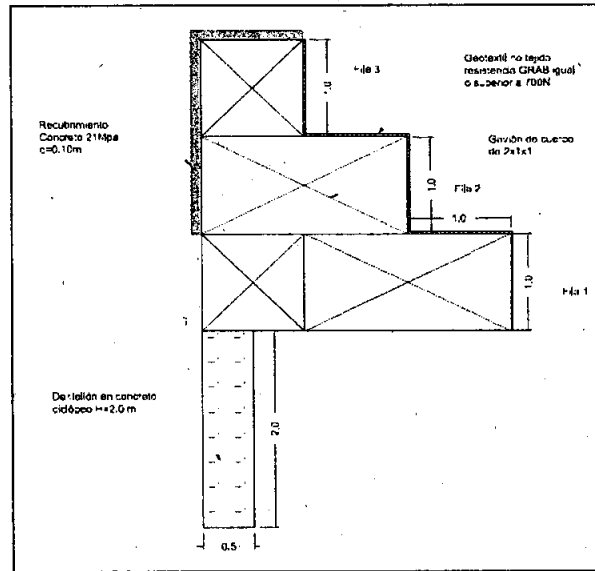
Detalle en perfil de muro en gavión H=3.0 m y dentellón en concreto ciclopeo de 2.0 metros de profundidad
